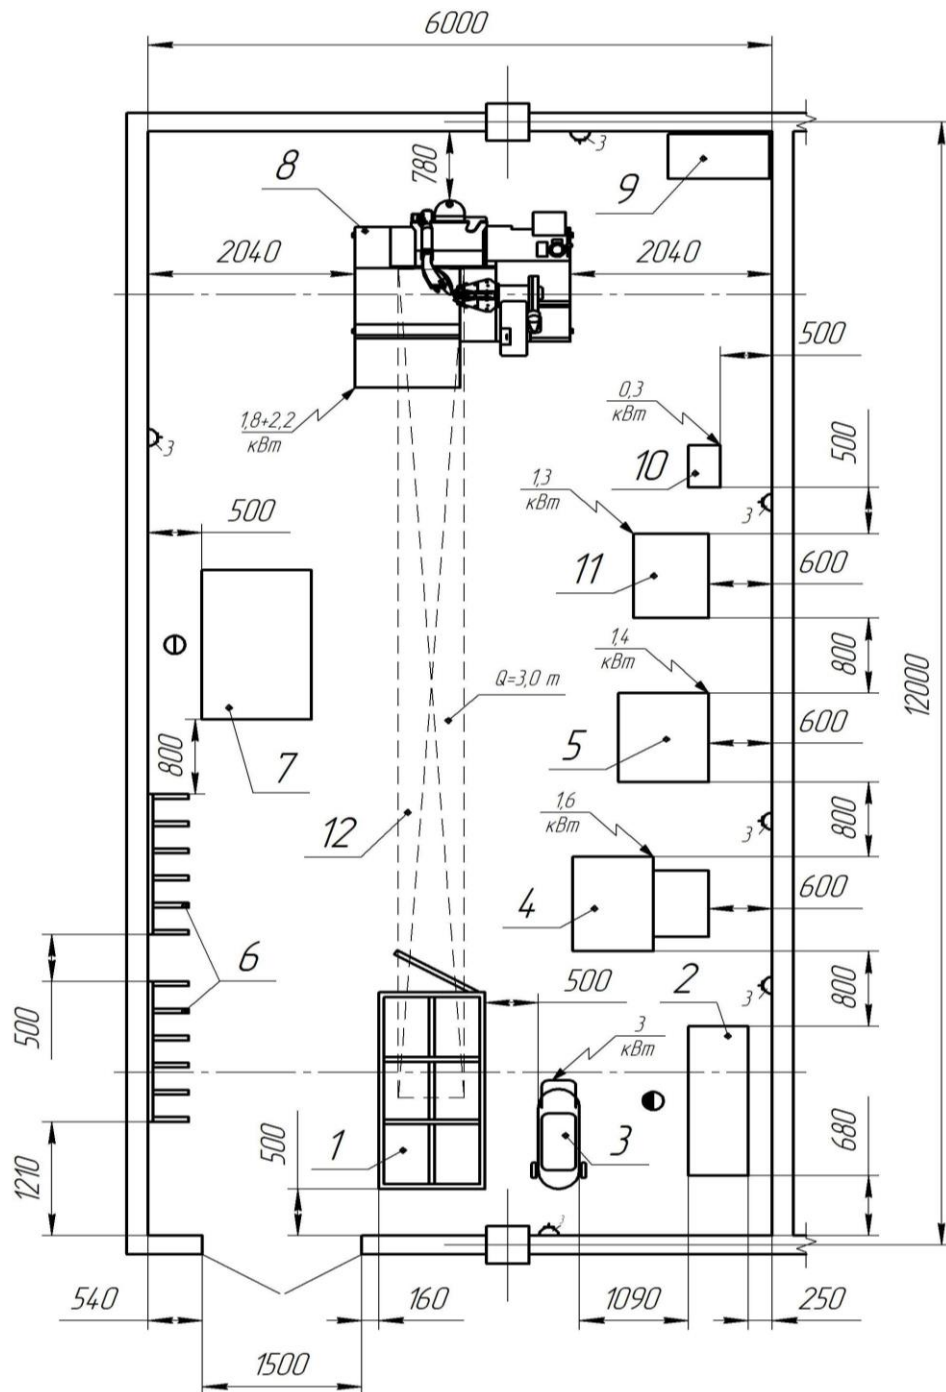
Схема розміщення обладнання шиномонтажної дільниці: 1 – захисна клітка для накачування шин; 2 – слюсарний верстак; 3 – повітряний компресор; 4 – електровулканізатор для ремонту великогабаритних шин; 5 – електровулканізатор для ремонту шин вантажних автомобілів; 6 – вішалка для зберігання камер; 7 – ванна для мийки коліс; 8 – шиномонтажний стенд; 9 – шафа для інструментів та витратних матеріалів; 10 – електровулканізатор для ремонту камер; 11 – балансувальний стенд; 12 – електрична кран-балка.
